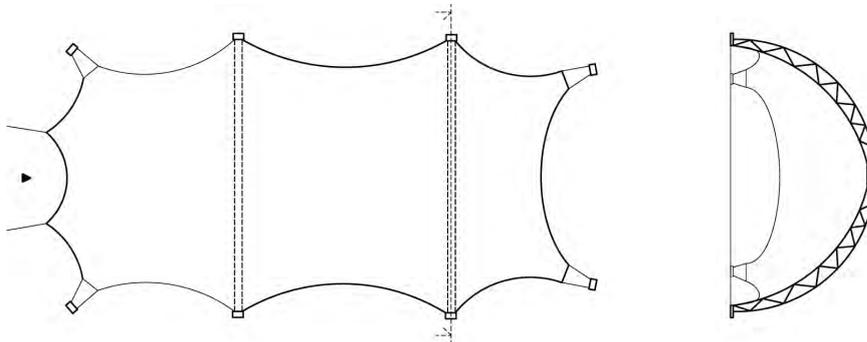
Membranbautyp 2B18-1M-1SL-1SM von *Spann-Bau* mit einer Grundfläche von 539 m², Grundriss und Querschnitt. Maßstab 1:500. *Eigene Darstellung*.
